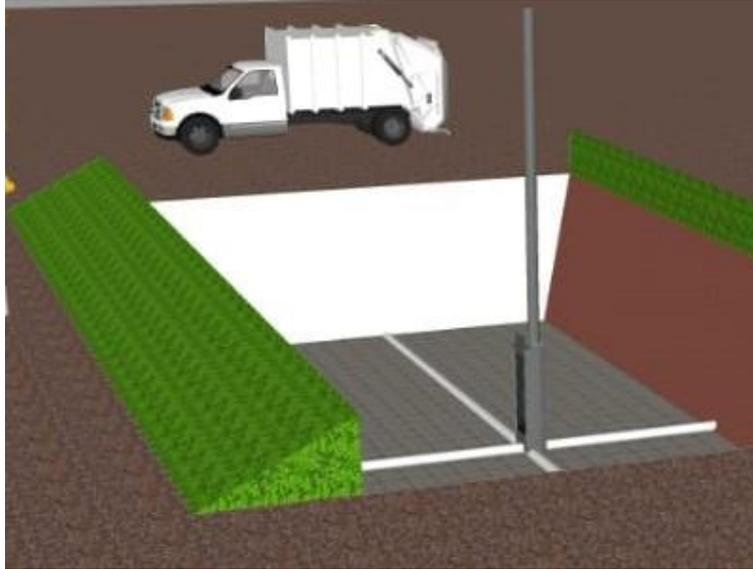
Drenajes de lixiviados. Fuente: elaboración propia.
